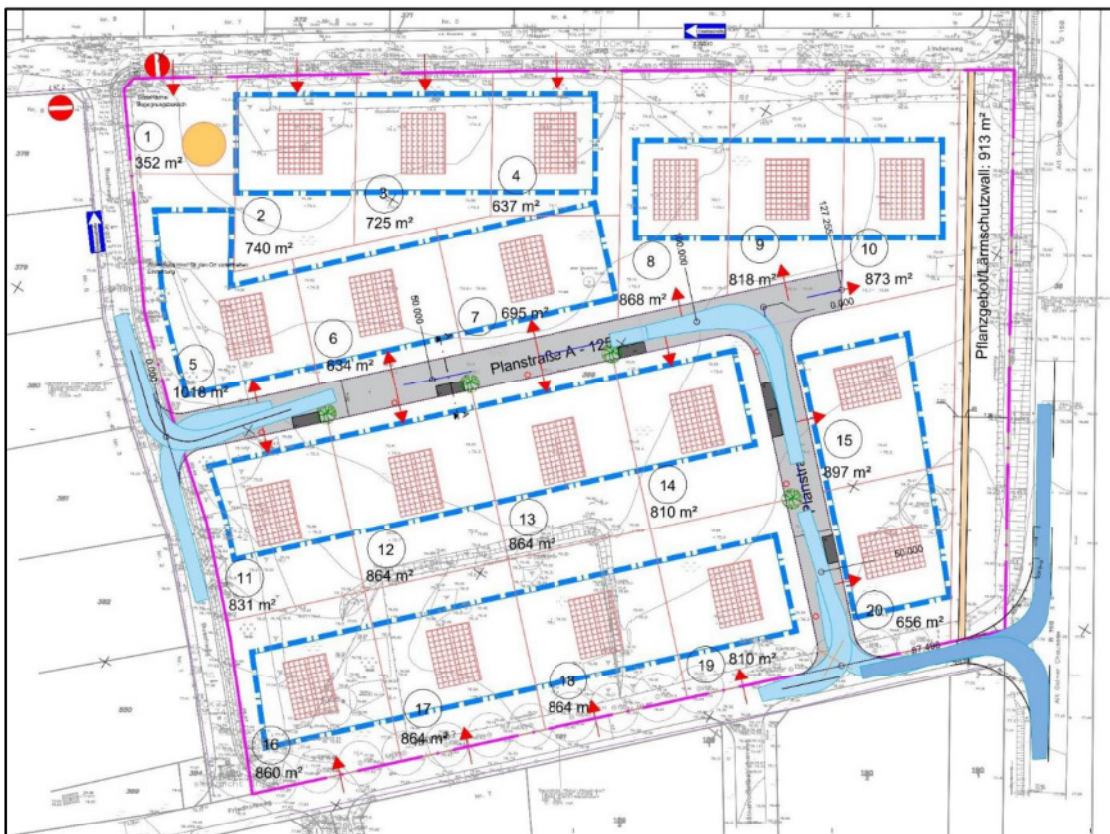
Lageplan Entwurfsplanung, Stand 12.07.2022
